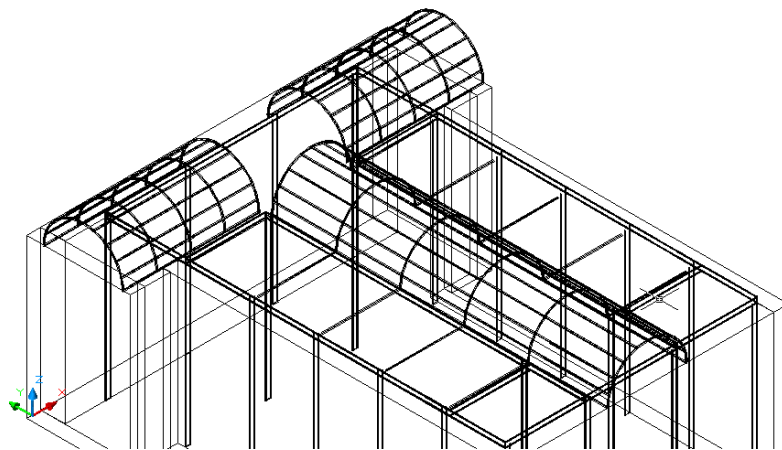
Vista Tridimensional de Bóvedas de Cañón Corrido
